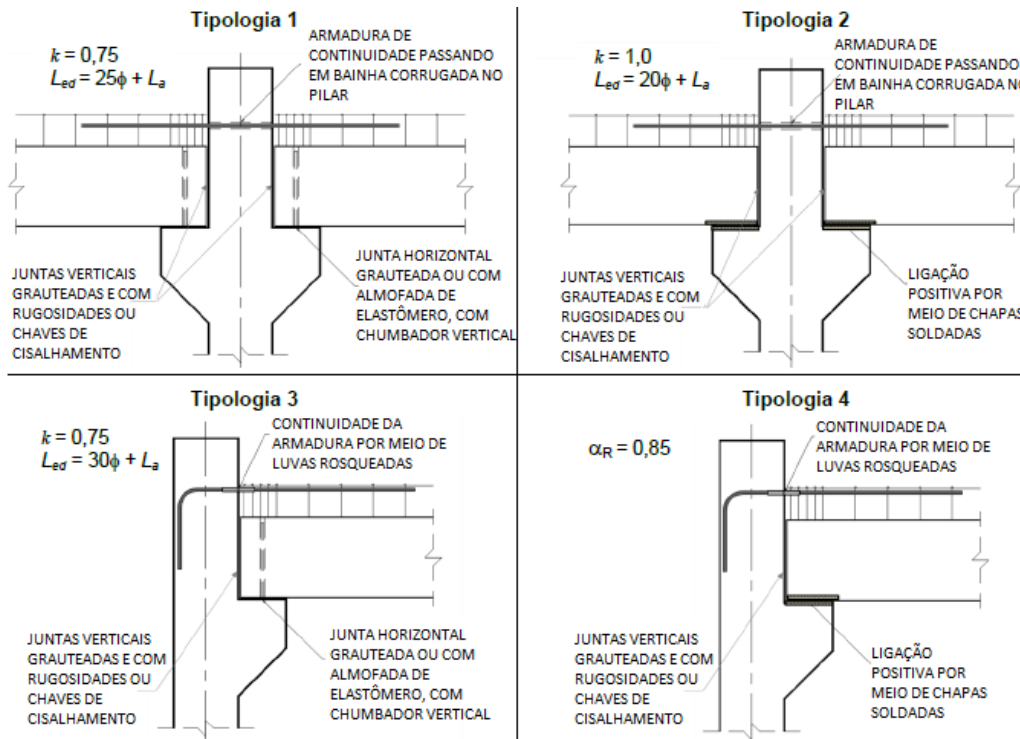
Ligações viga-pilar típicas. (ADAPTADO DE ABNT NBR 9062:2017)
